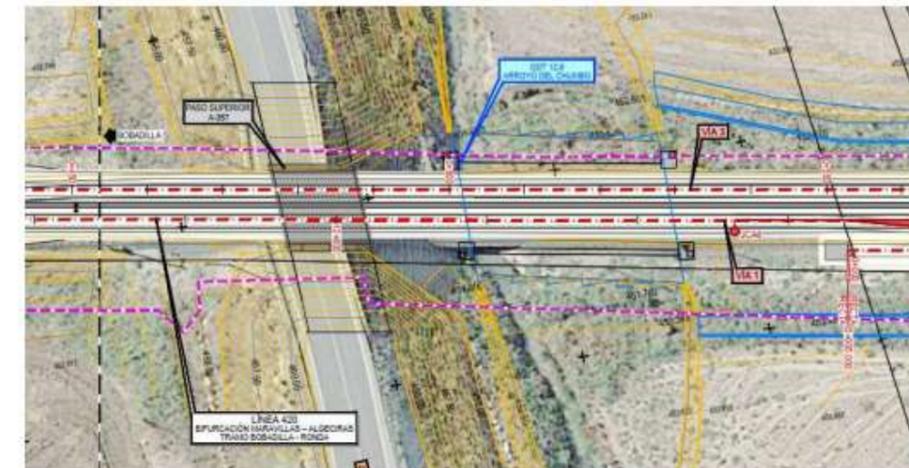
Planta de previsión de ampliación vías en estación Campillos.
